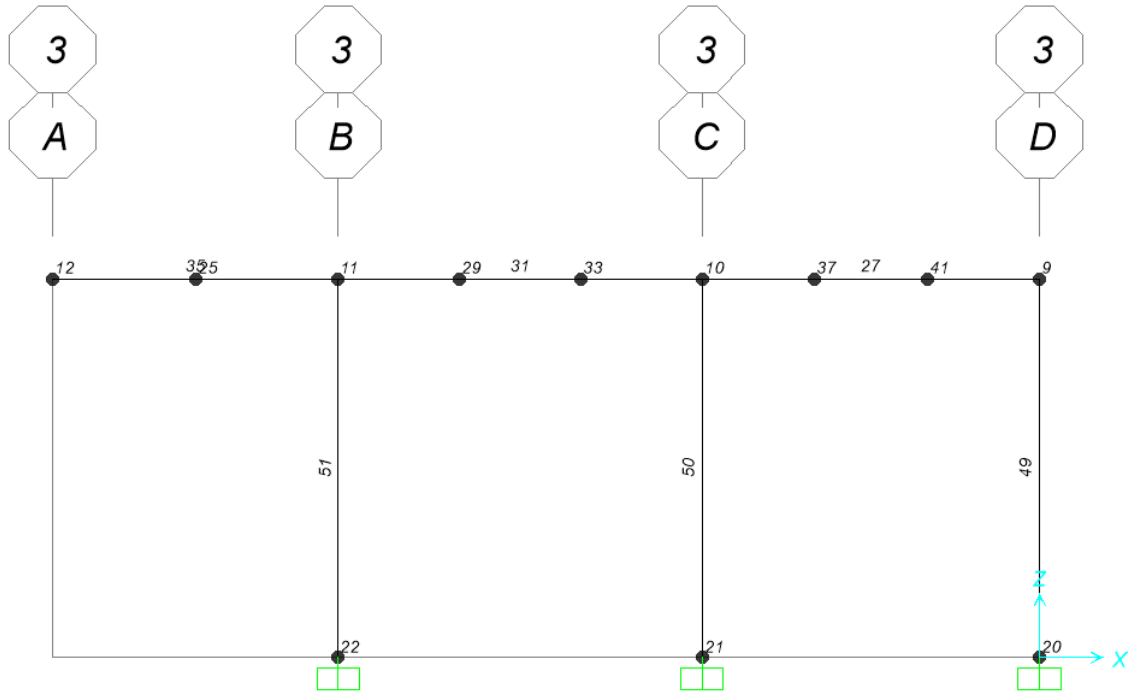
Vista in sezione modello struttura in elevazione –Filo 3 - numerazione elementi frame e joint
